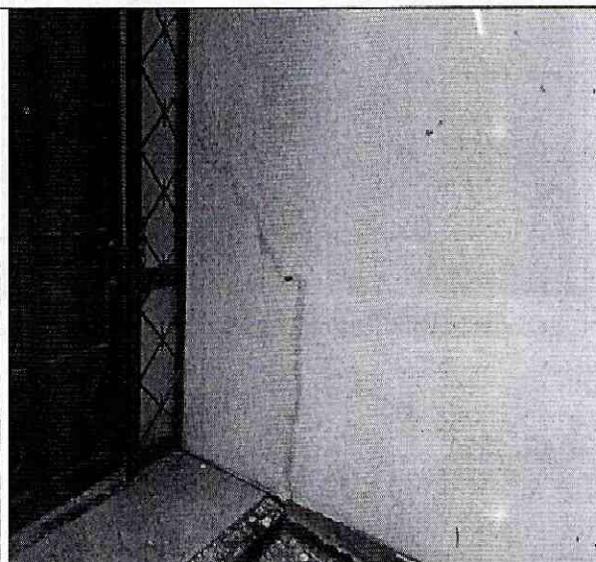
Grietas diagonal en muro de primer piso.
